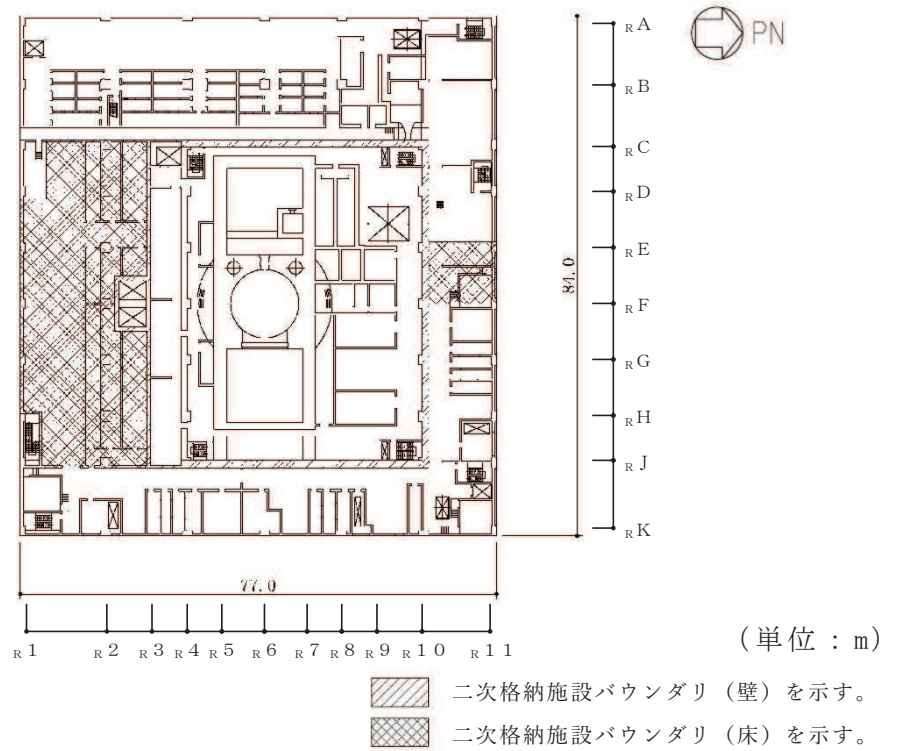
原子炉建屋原子炉棟（二次格納施設）の範囲の平面図
